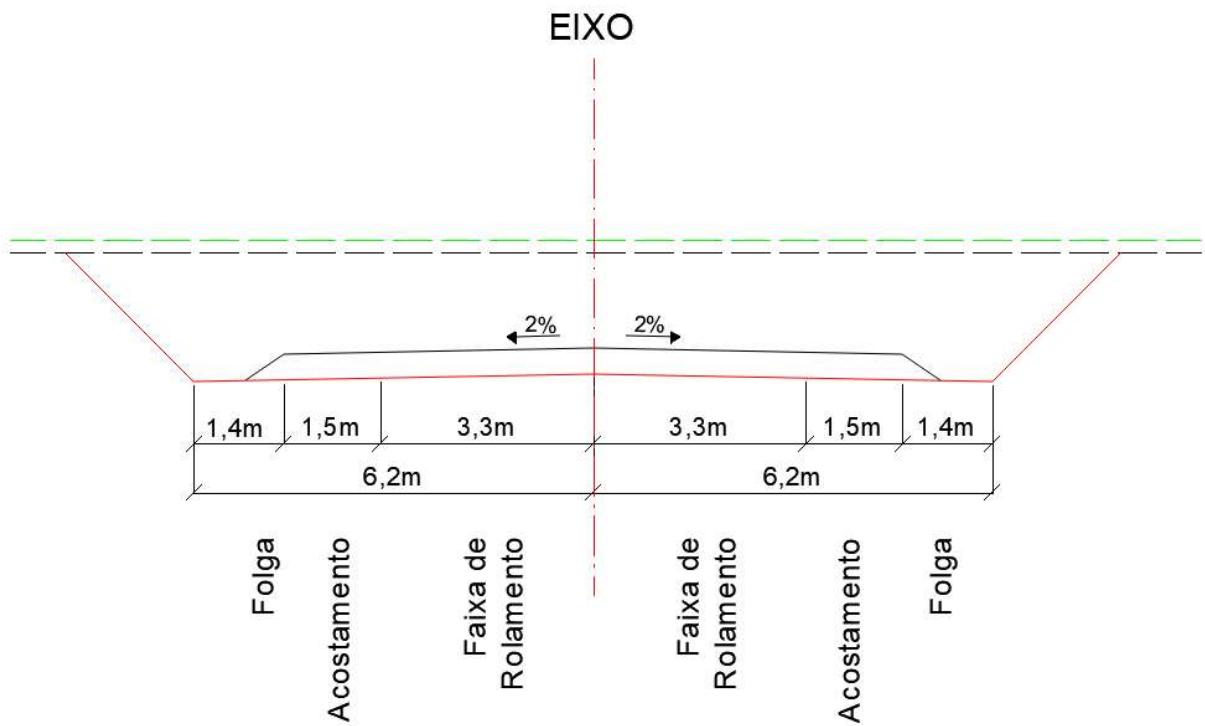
Seção Transversal em Corte (Proporção 1:1)
